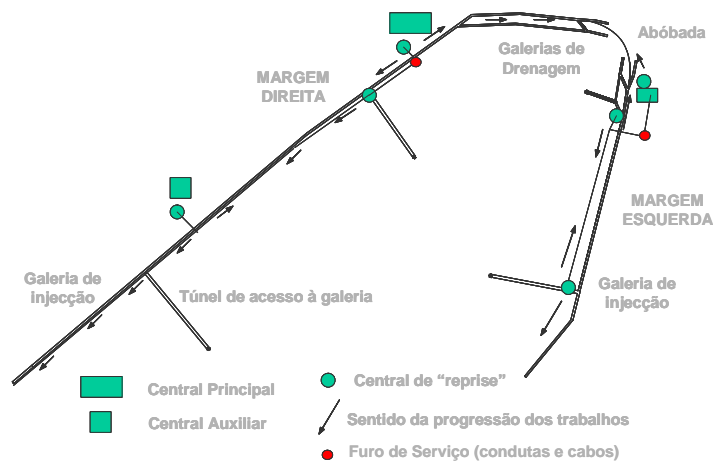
Planta das galerias de injeções da barragem de Ait Hammou
